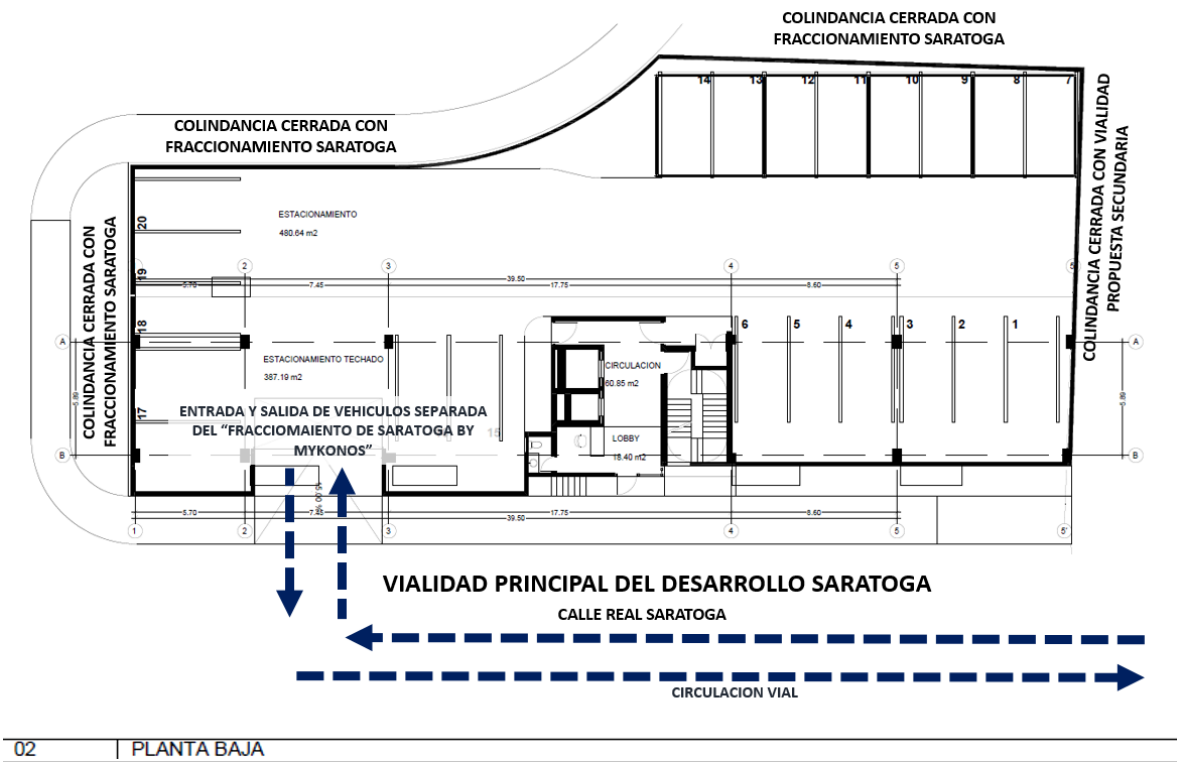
Esquema de Acceso a Planta Baja. Fuente: Elaboracion Propia 2025.
